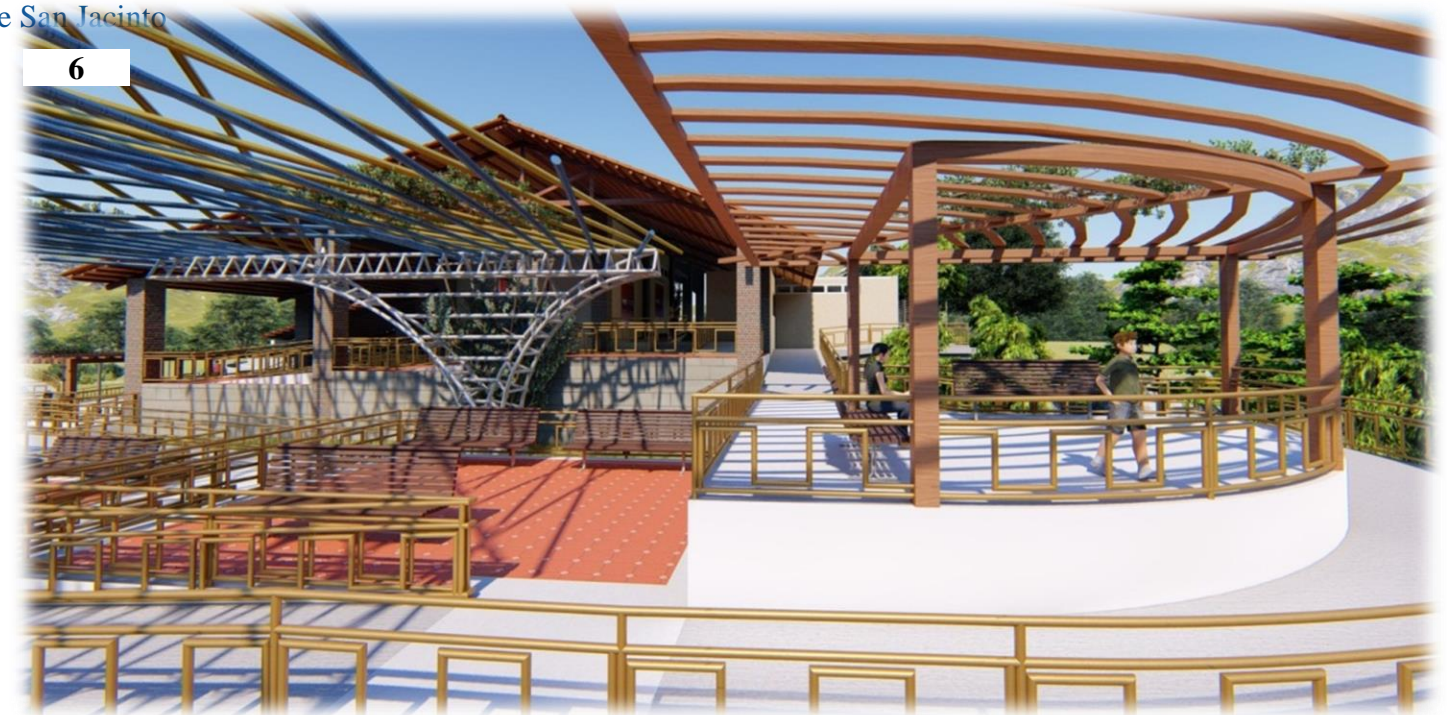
Perspectivas de Norte a Sur viendo hacia la primera plaza externa conectada desde el área de parqueo con rampas y que acceda a otras a diferentes niveles de la más alta a la más bajas por el lado externo del Centro Turístico.
